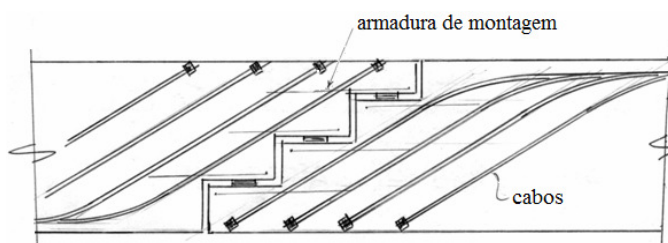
Detalhe das armaduras internas propostas para vigas de concreto protendido.
